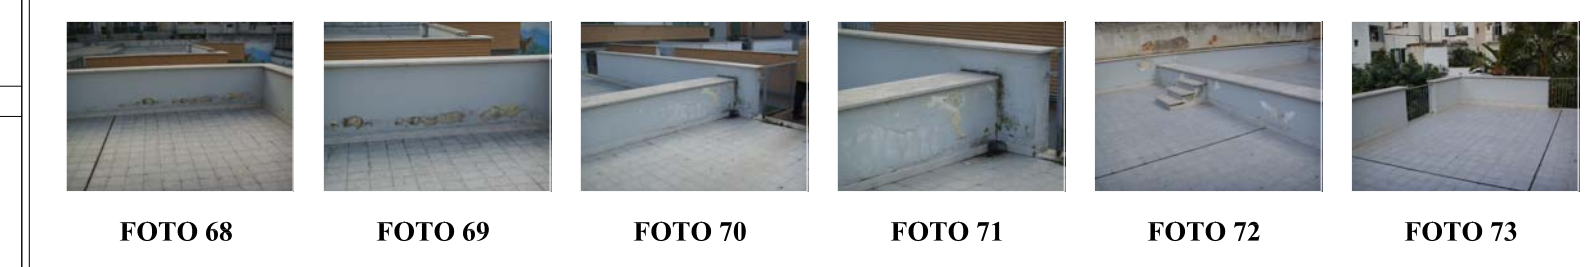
FOTO 69 FOTO 70 FOTO 71 FOTO 72 FOTO 73
